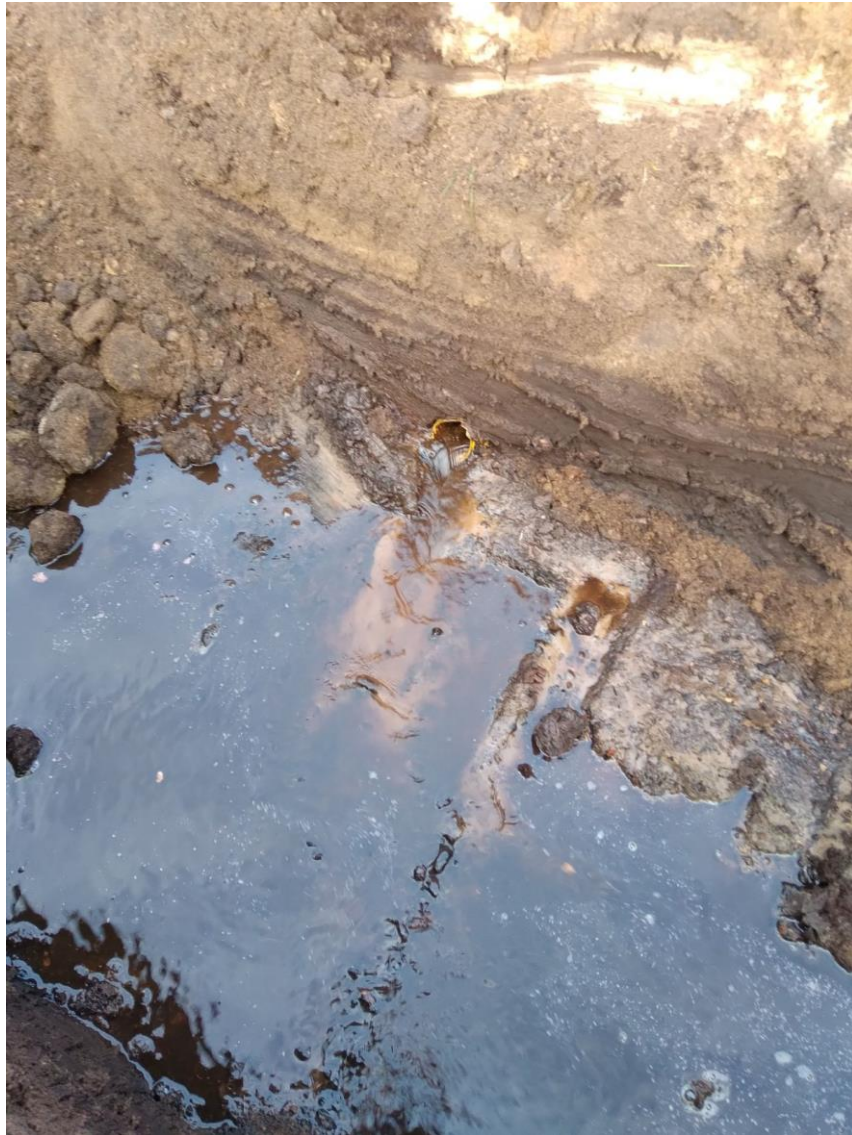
Kompensationsfläche A – Flurstück 67/5 – Durchtrenntes östlichstes Drainagerohr (H&M 09.03.2023)
